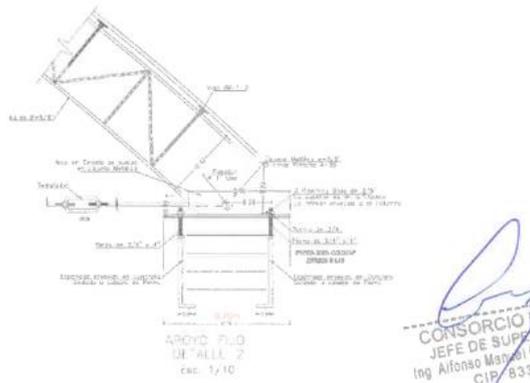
Detalle de apoyo de estructura metálica en elemento de concreto armado
